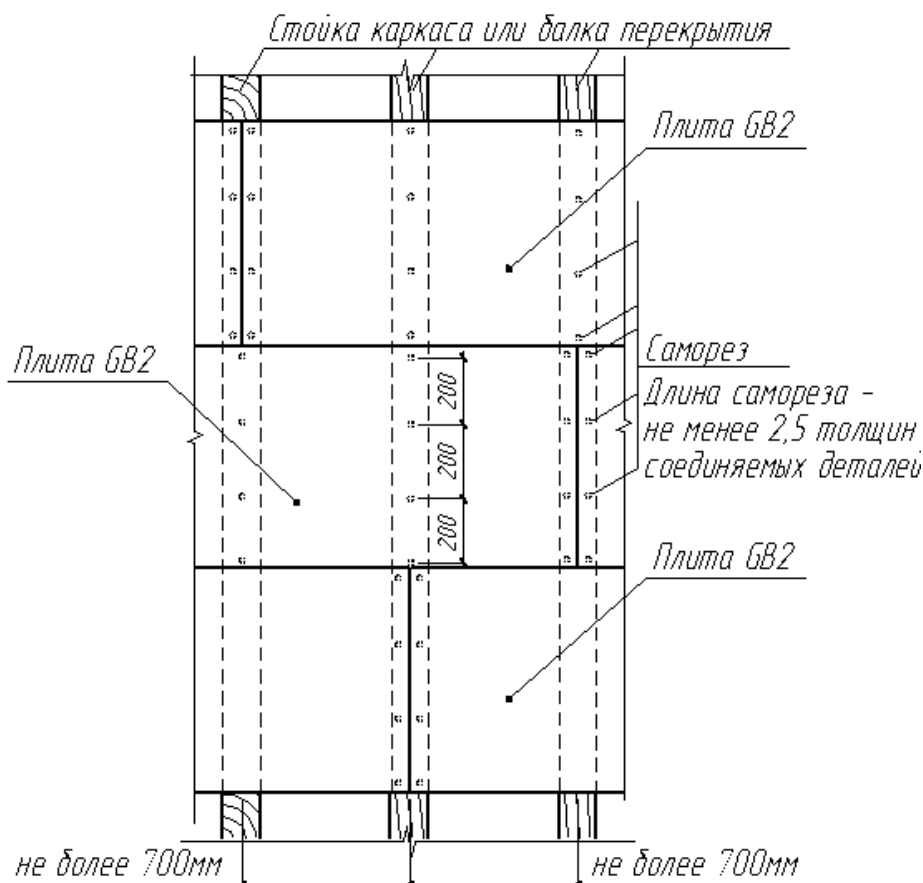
Крепление плит GB-2 к стойкам каркаса
